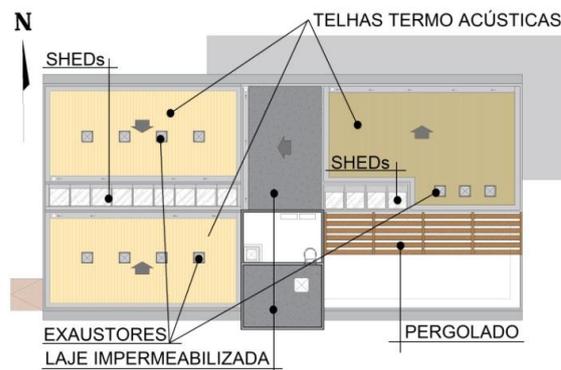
Planta de cobertura. Fonte: Elaborado pelos autores.
